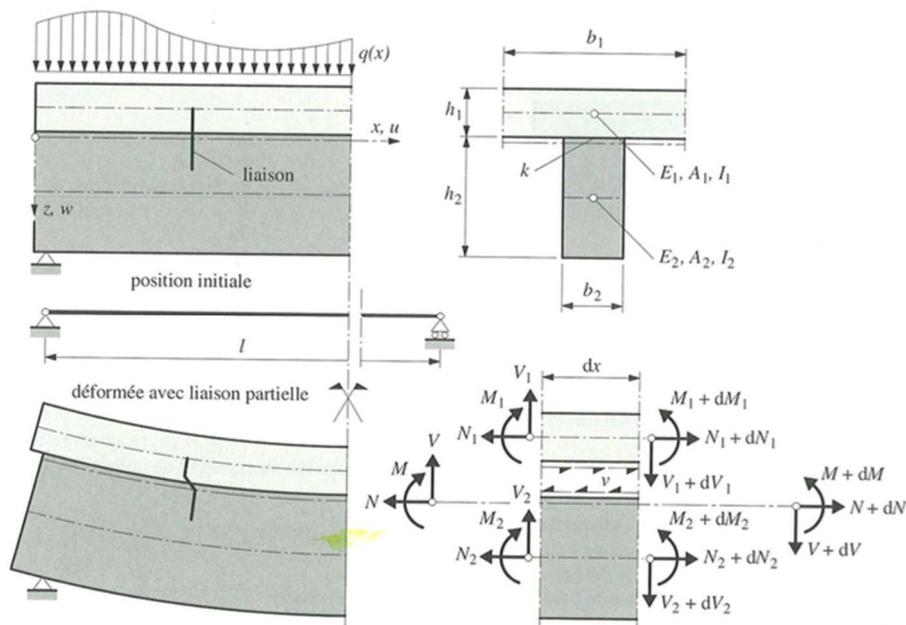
Haut : Coupe et section d'une poutre connectée par une liaison mécanique et chargée d'une charge sinusoïdale¹ $q(x)$.
